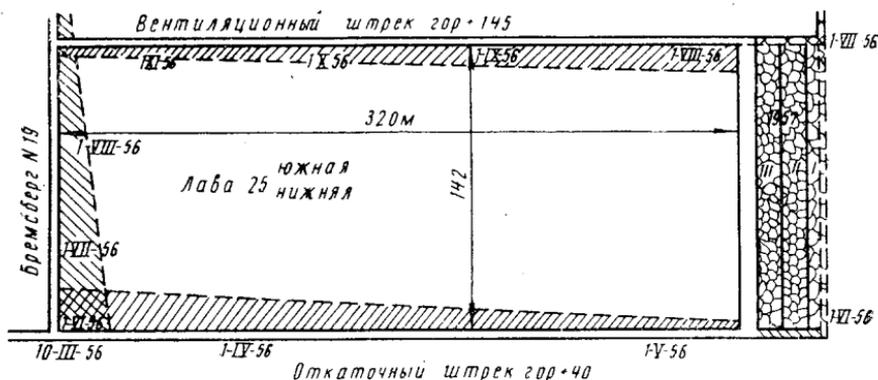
Схема дренажирования угольного пласта Е-6 подготовительными выработками на шахте Капитальная-II
